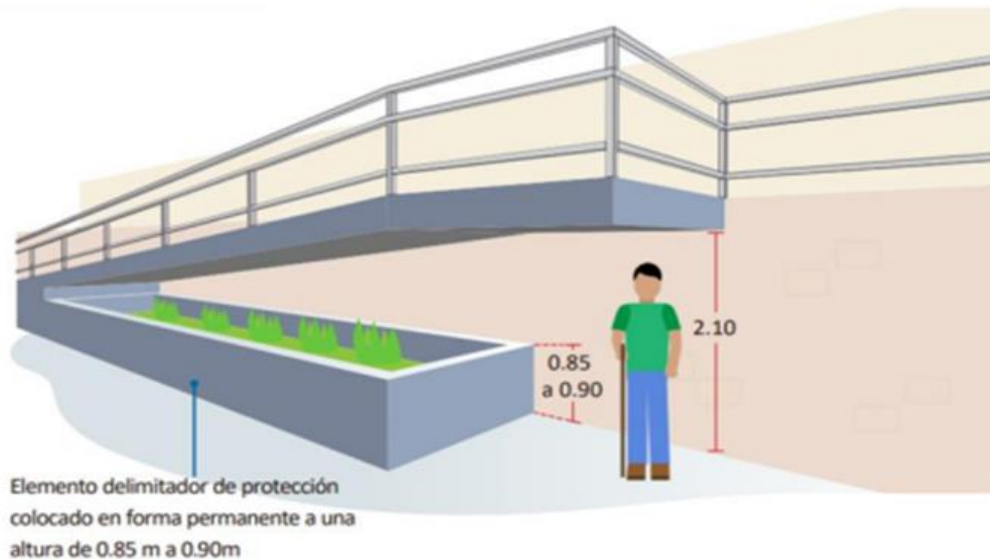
Colocación de elemento delimitador bajo rampa o escalera
